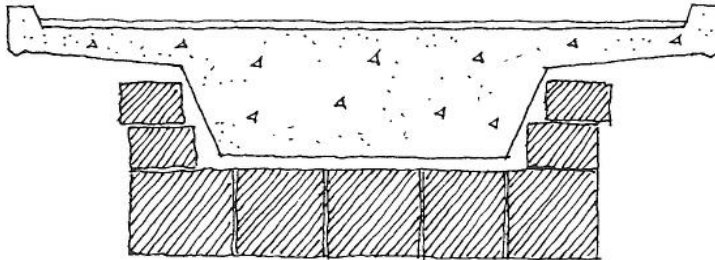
Hvelv med overliggende betongplate som hviler på hvelvet.
